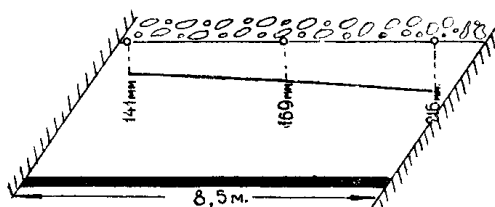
Сдвигение кровли горизонтальных слоев при разработке пласта IV Внутреннего на шахте «Коксовая-1» с пневматической закладкой
